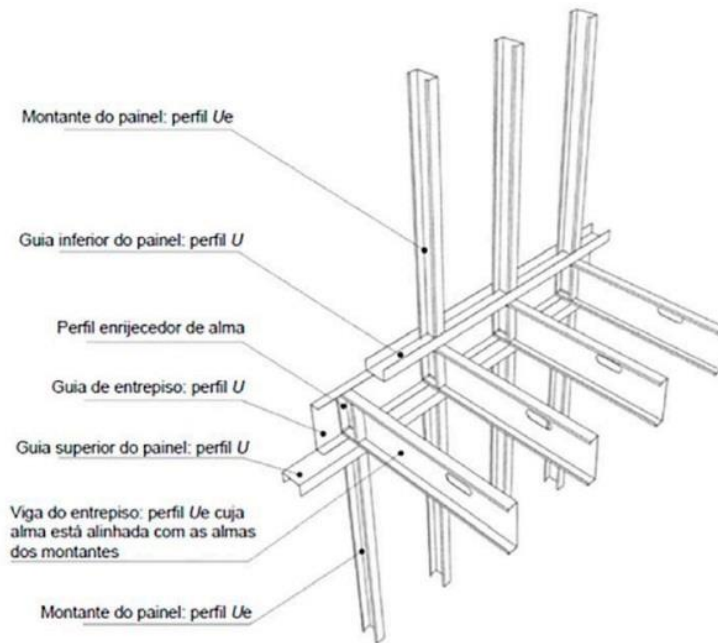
Elementos de uma estrutura em *Light Steel Frame*.
